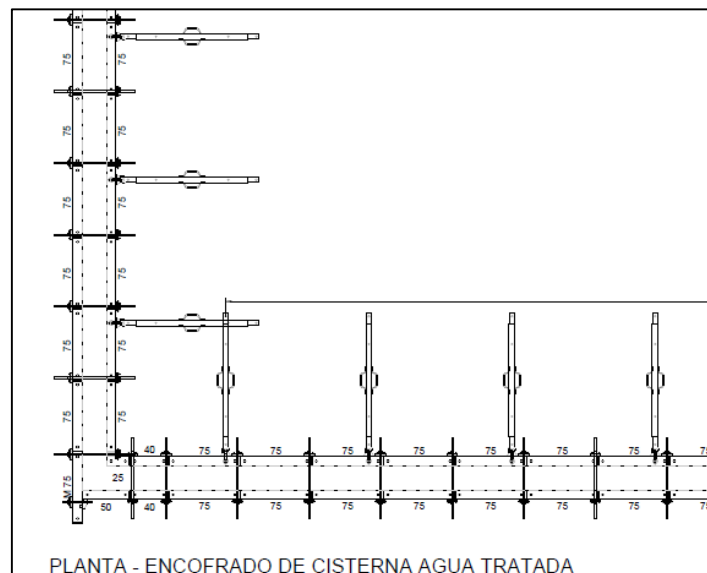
Distribución de planchas de encofrado modulado.
